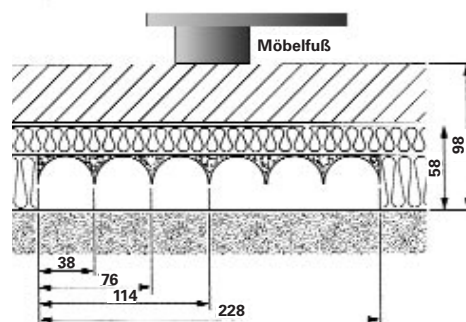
Schaumstoff-Hohlprofile (Rohrdurchmesser 12 mm, Dämmschichtdicke 13 mm)
